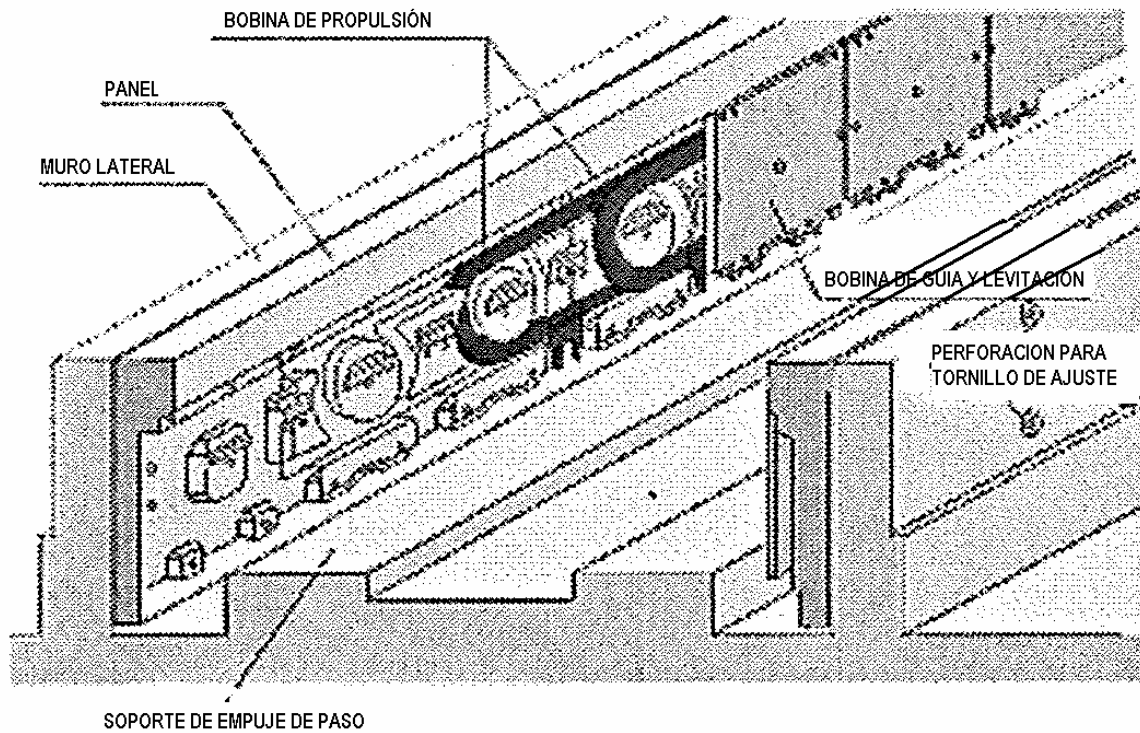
ESTRUCTURA IN-SITU Y PANELES PREFABRICADOS
